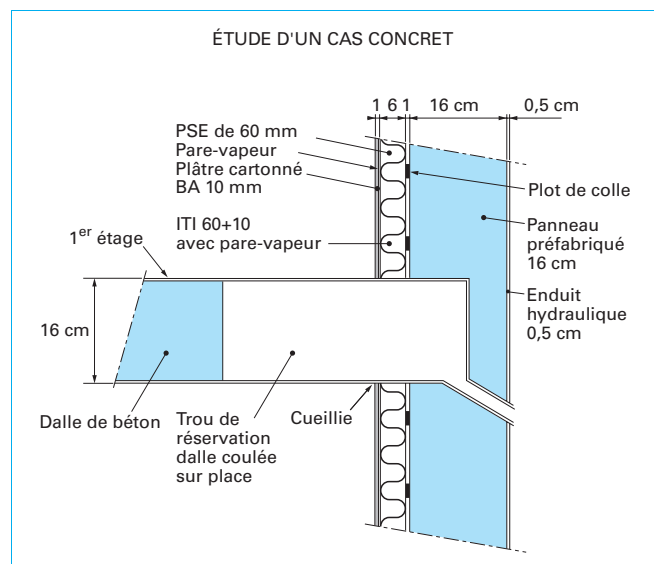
Coupe verticale au droit de la liaison dalle du 1^{er} étage avec les panneaux préfabriqués du rez-de-chaussée et du 1^{er} étage
